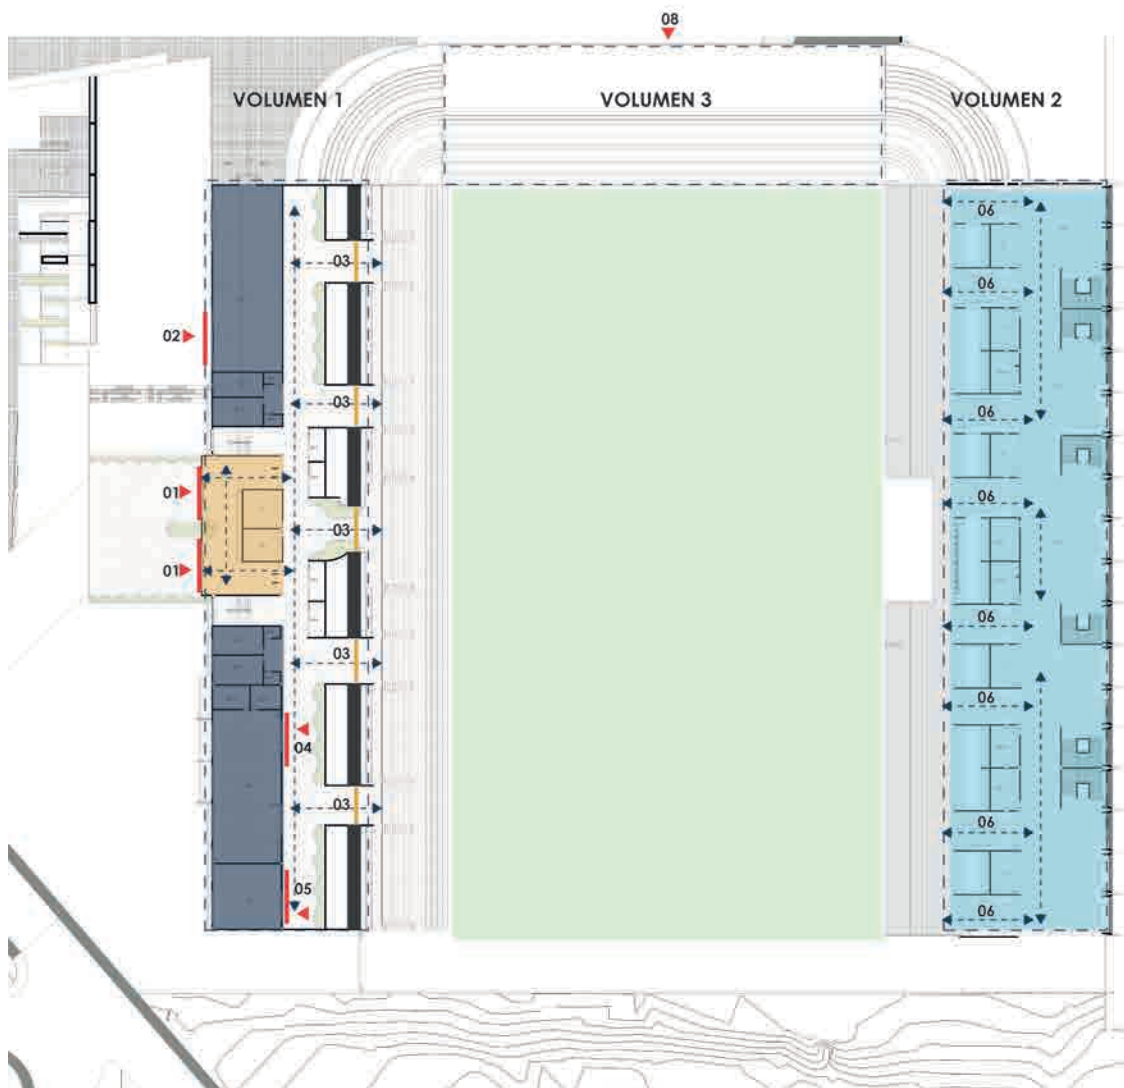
Primera planta alta. Elaboración: Autores.
